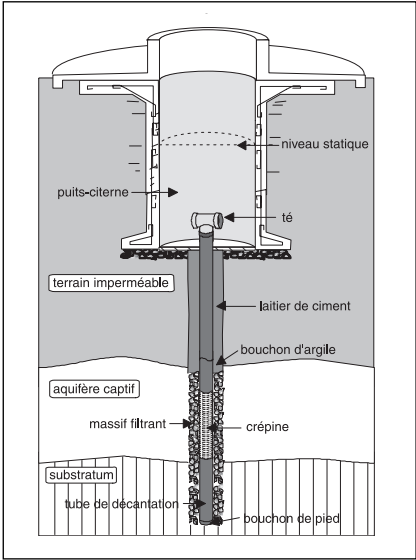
Puits sur forage concentrique (ACF, Cambodge, 1998)
